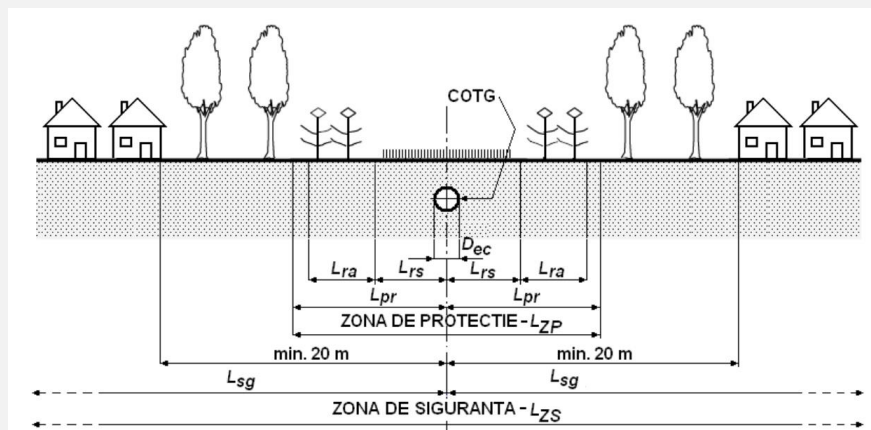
Planul zonelor de protecție și de siguranță ale unei COTG
